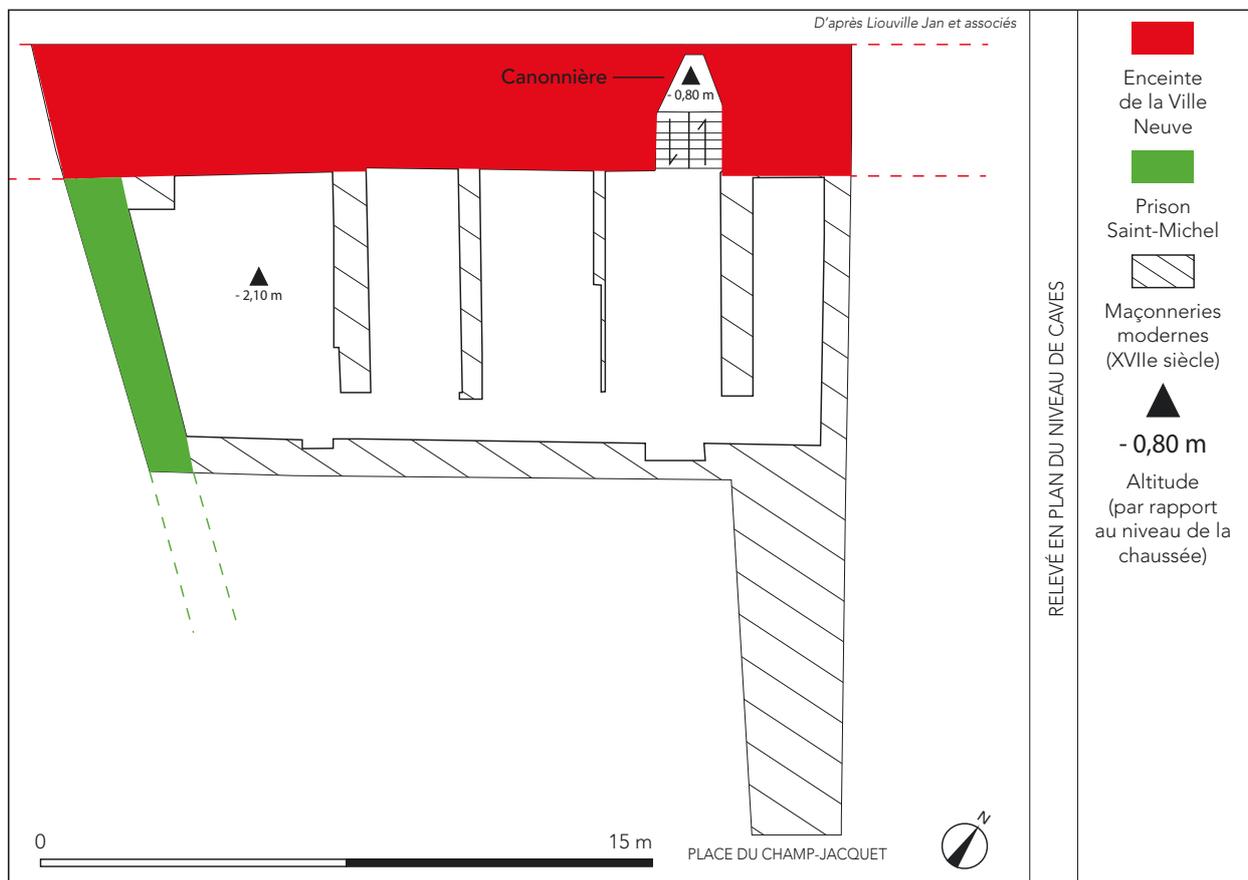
Relevé en plan du niveau de caves du 7, place du Champ-Jacquet (d'après un plan levé par le cabinet d'architectes Liouville Jan et associés)
